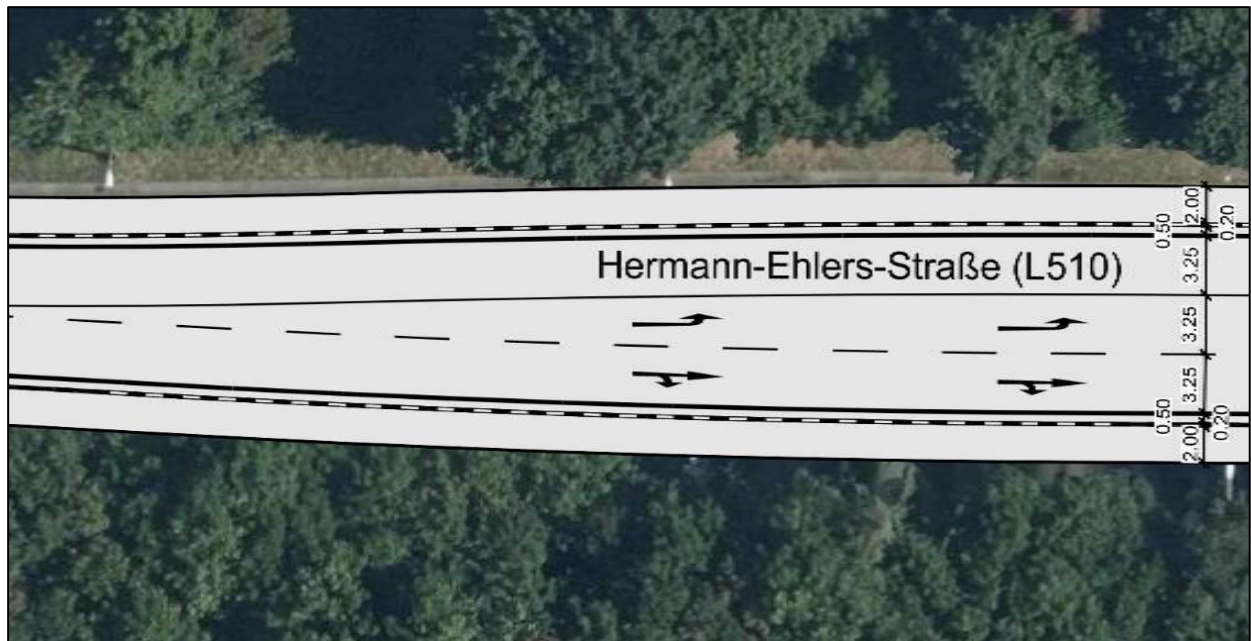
Lageplanausschnitt der Variante „Protected Bike Lane“ [1]
